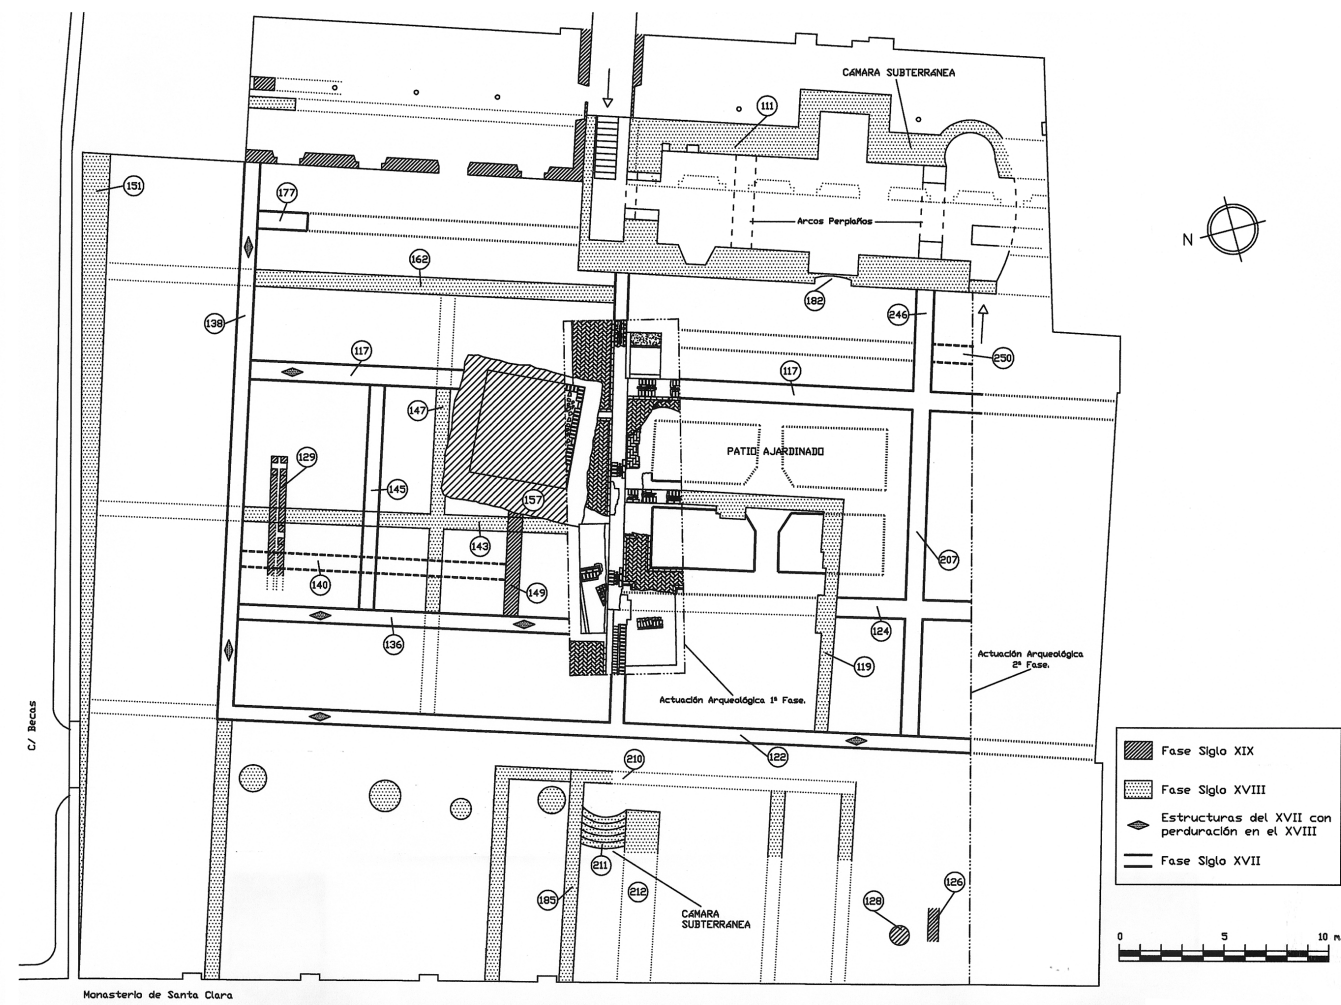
Planta general del conjunto de estructuras localizadas en la parcela de calle Becas s/n.
